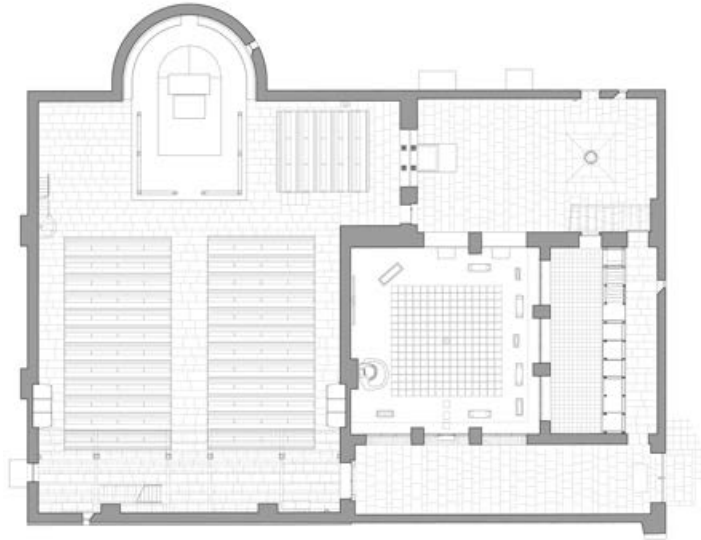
Grundriss der Kirche St. Johann Baptist, Bauaufnahme des Lehrstuhls für Architekturgeschichte der RWTH Aachen
